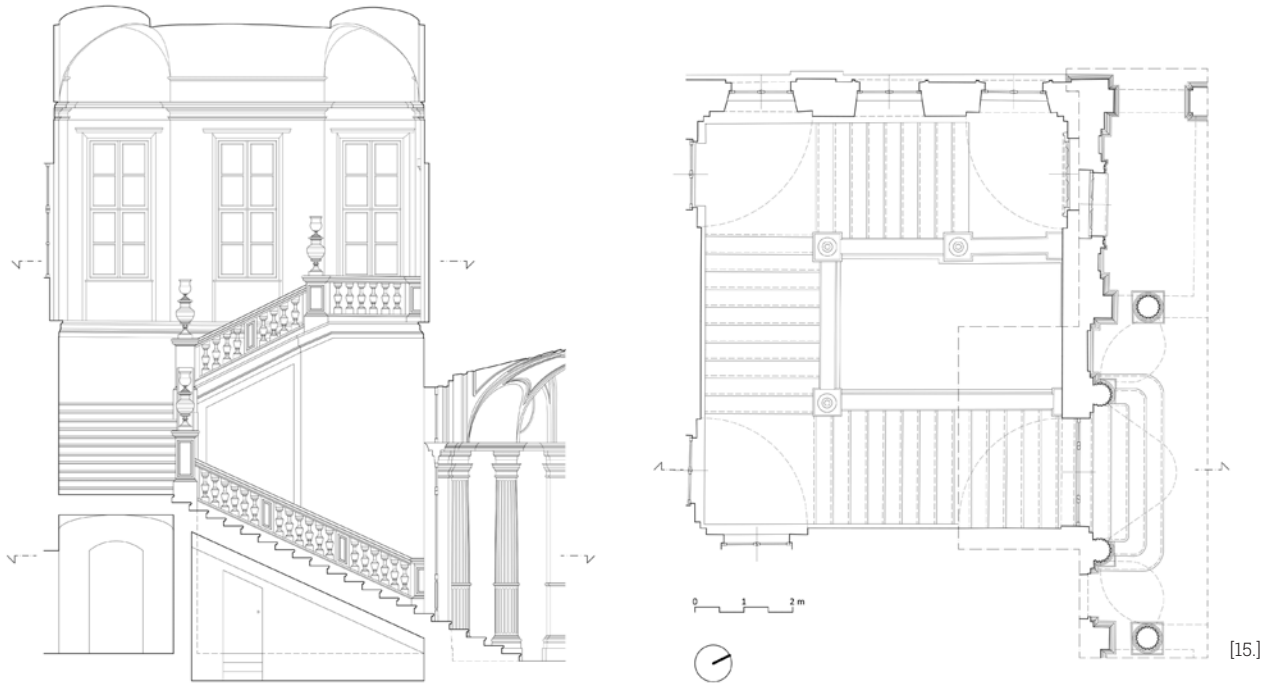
Palazzo Birago di Borgaro*. Sezione trasversale e pianta dello scalone [disegni di Fabrizio Natta].
